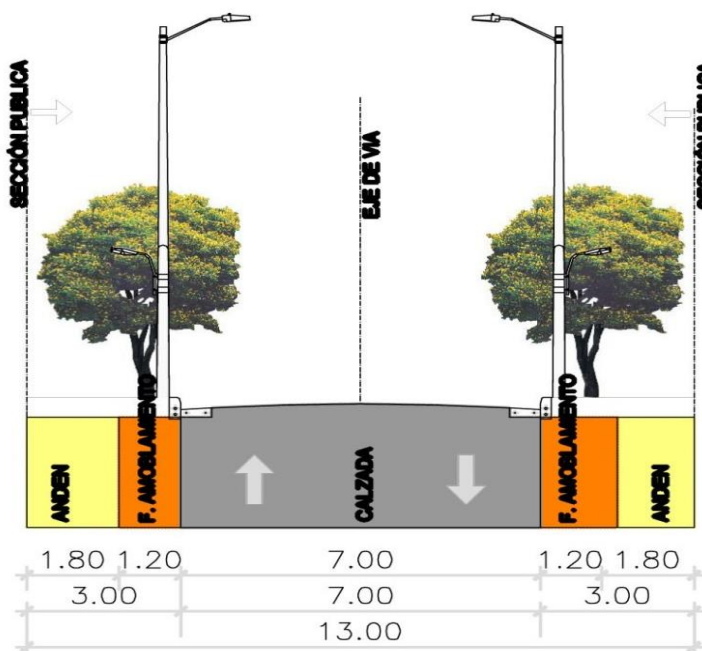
Sección vial típica proyectada para desarrollos viales de la zona de expansión
